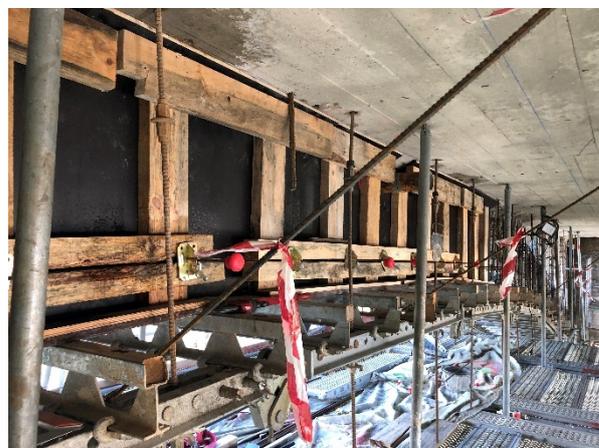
Detalle de mesas de encofrado colgado en recrecido de arco.
